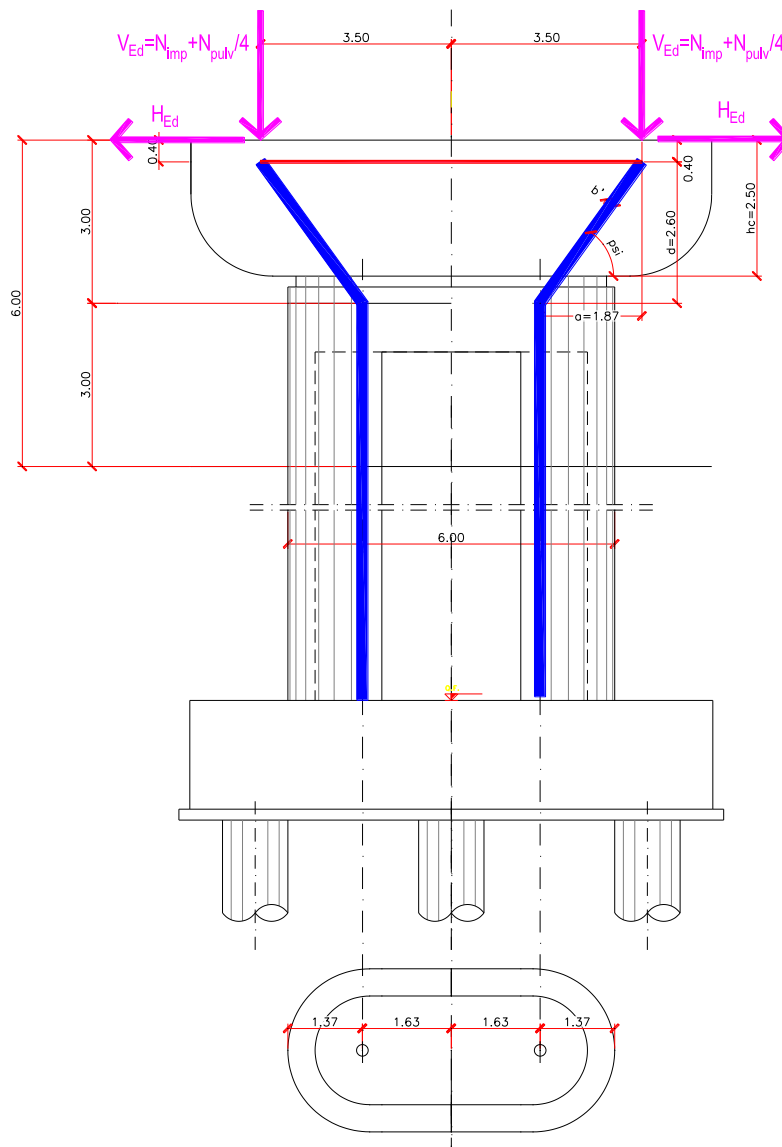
Schema statico per verifica pulvino - Pila Tipo
